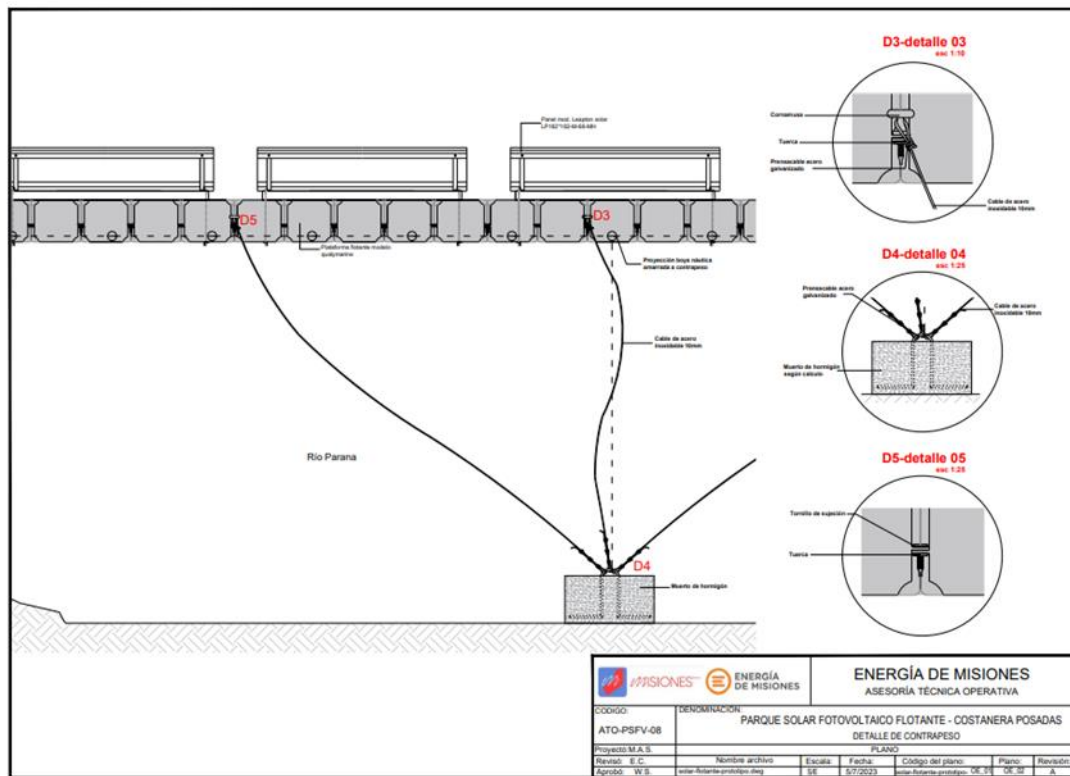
Sistema de amarre: mediante amarres de hormigón armado sumergidos
